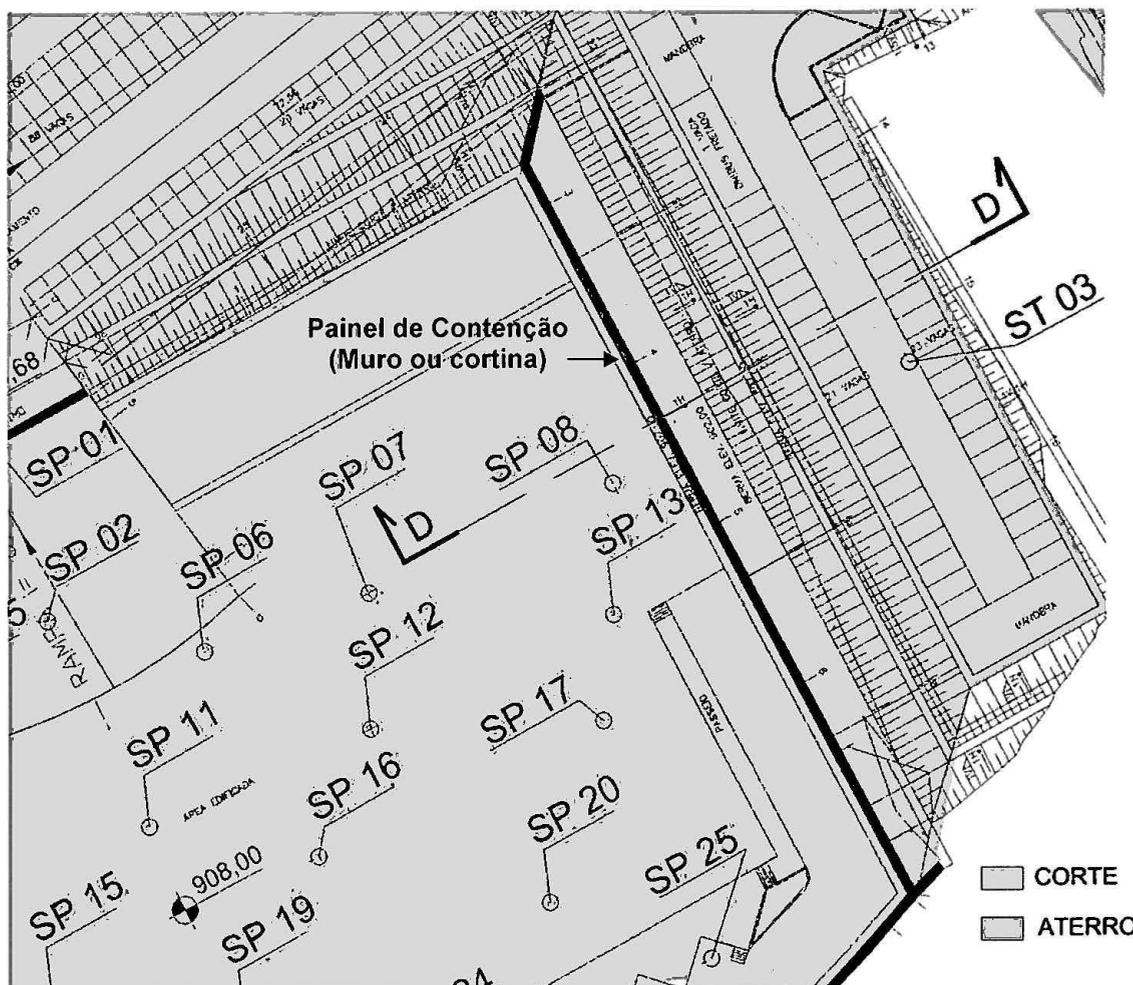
Estruturas de contenção a serem implantadas e definidas para a execução da terraplenagem local.
